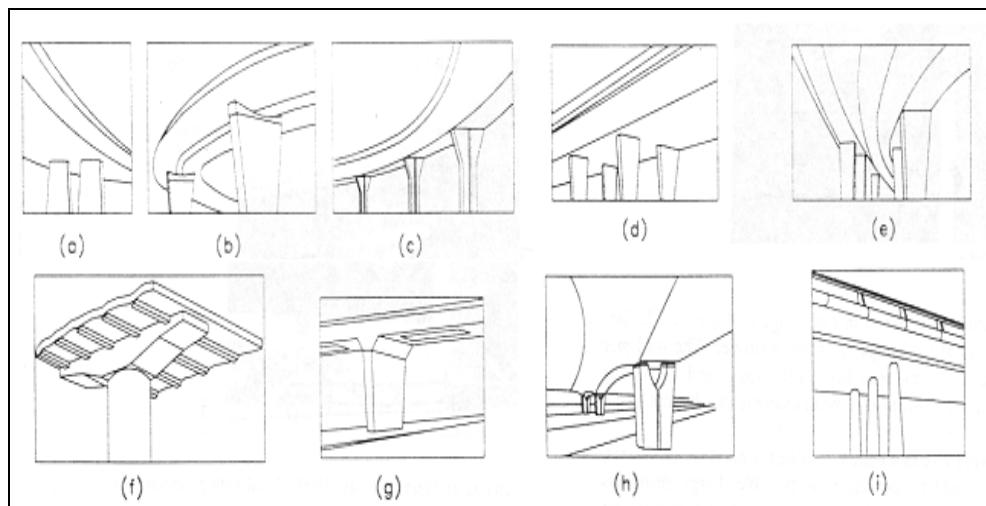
Estilos de pilas de puentes contemporáneos: pilas tipo pared (a-e, g, h); tipo T (f); y tipo columna (i).
